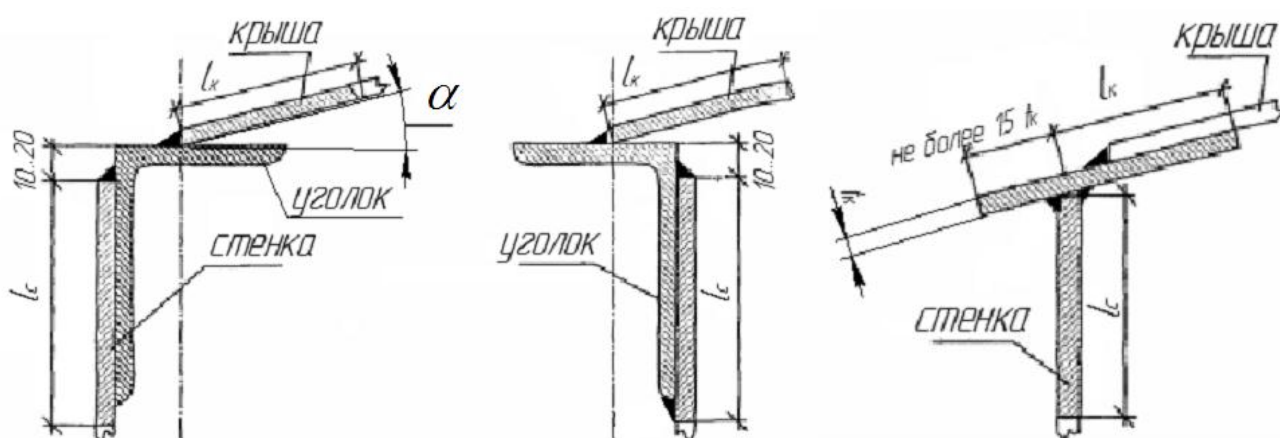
Схема нагружения бескаркасной конической крыши и варианты узла опирания ее на стенку
